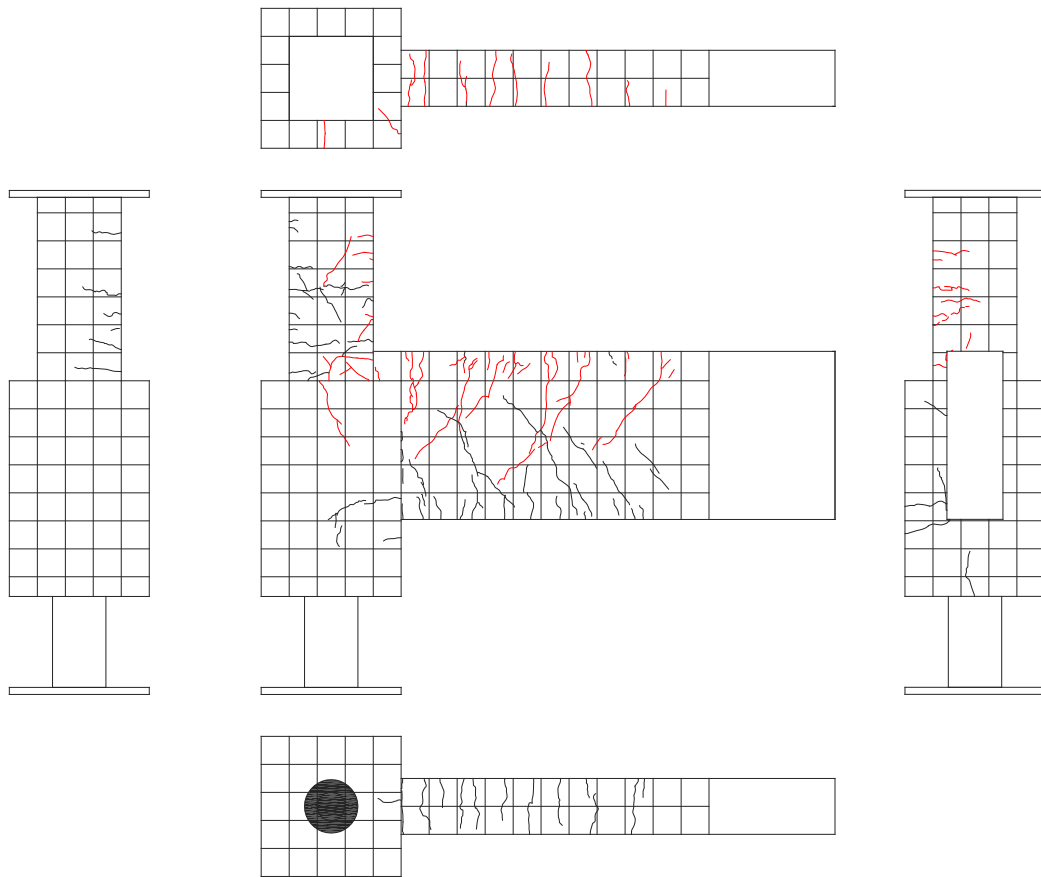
試験体 A-6 ひび割れ状況 (3Cycle)
